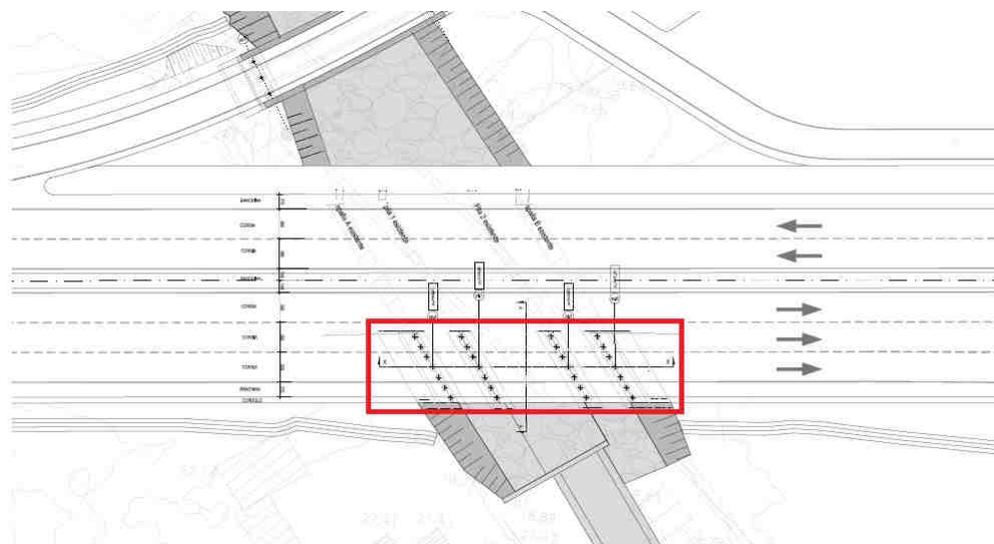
Planimetria dell'impalcato – Ponte Rio Salius
